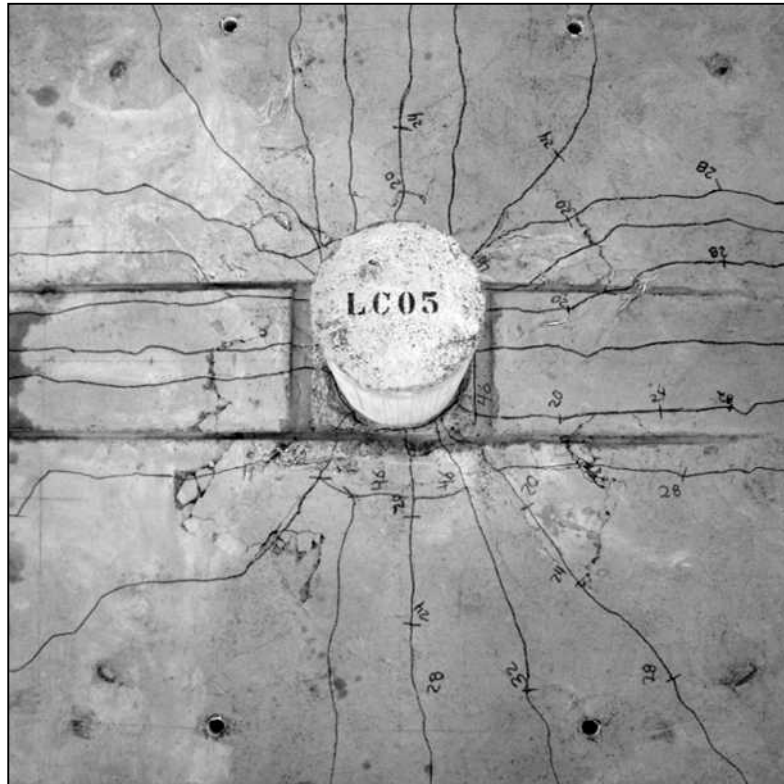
Mapa de fissuração da laje LC05
